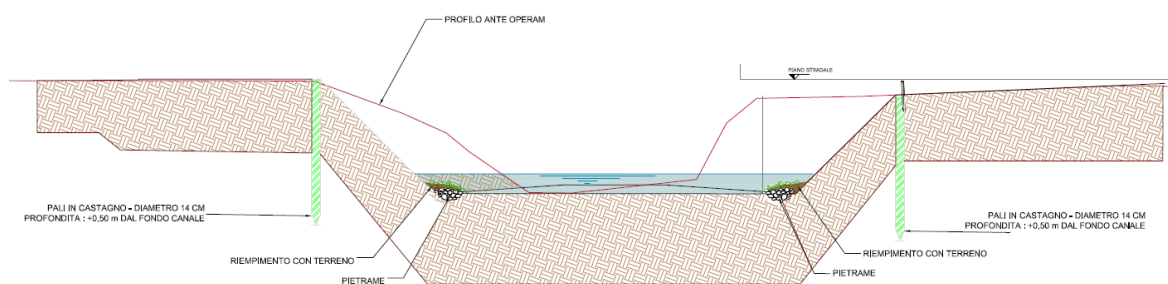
Esempio di sezione di ripristino dell'alveo originale del canale Dei Cupi e ubicazione pali in castagno
